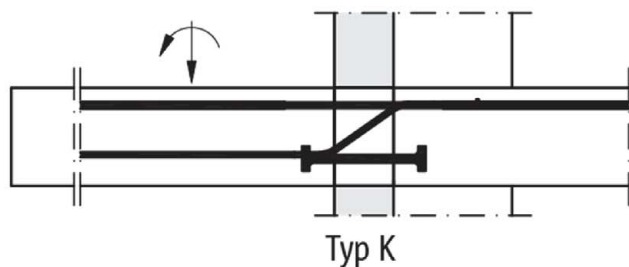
Schöck Isokorb® Typ K, K-F (Variante mehrteilig) für frei auskragende Balkone mit Stahldrucklager mit angeschweißten Druckplatten
